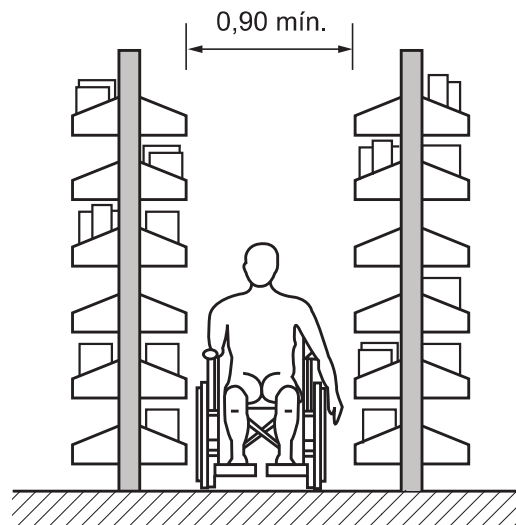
Estantes em bibliotecas – Exemplo – Vista frontal
